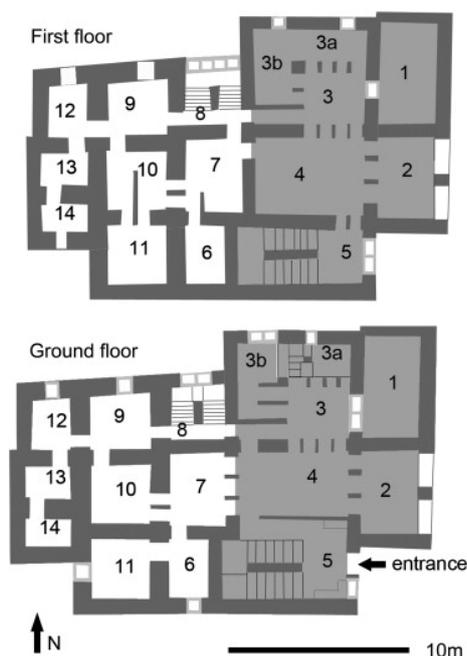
Planimetria di Xeste 3 (da Palyvou 2005, p. 55)
